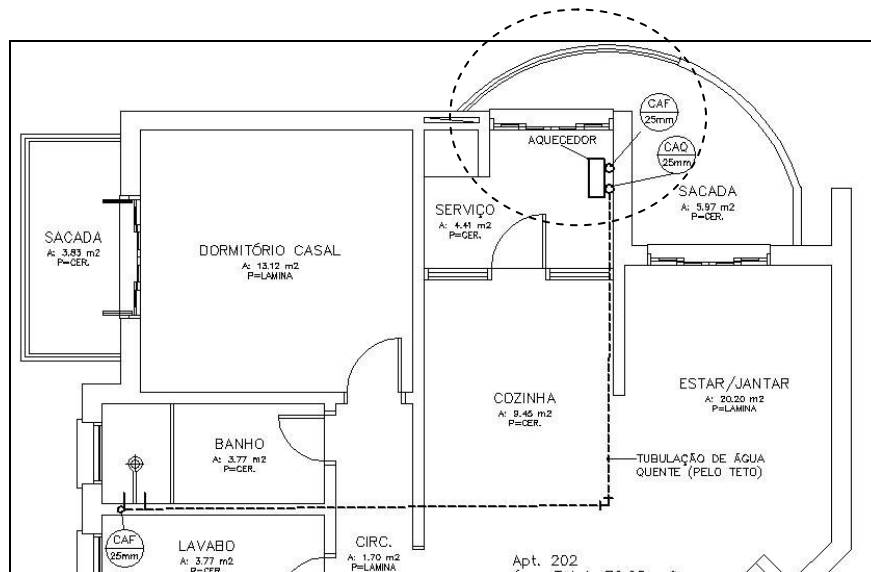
Sistema de aquecimento de água a gás em planta (sem escala)
